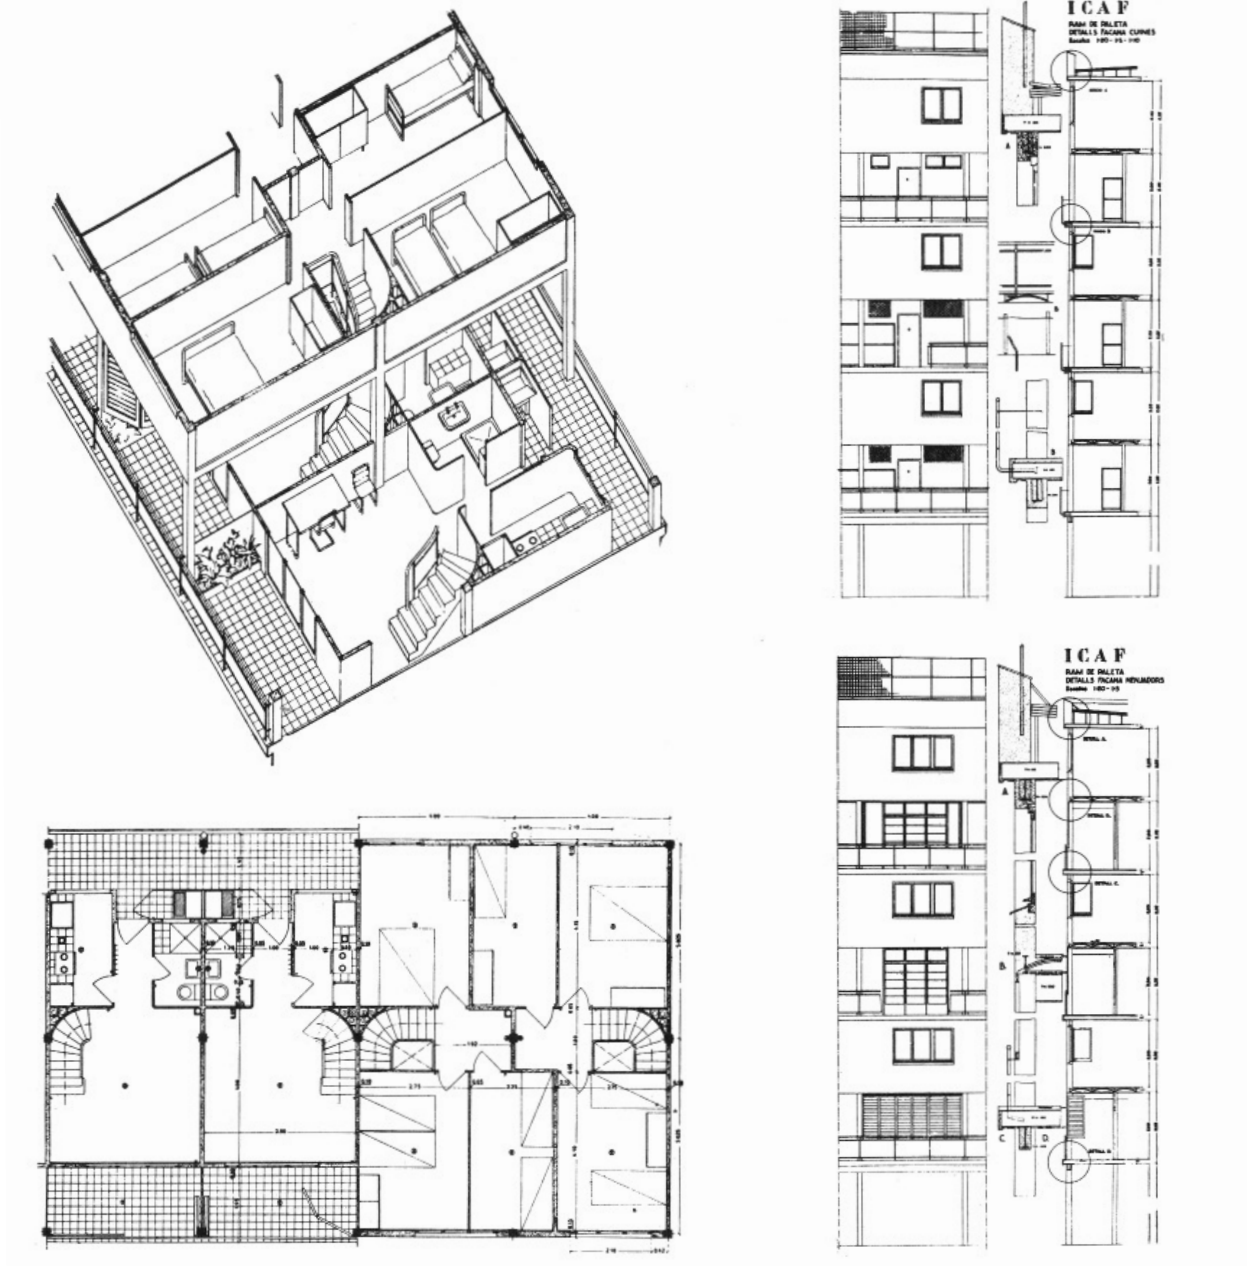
Axonometría interior, plantas y secciones-alzado constructivas.
